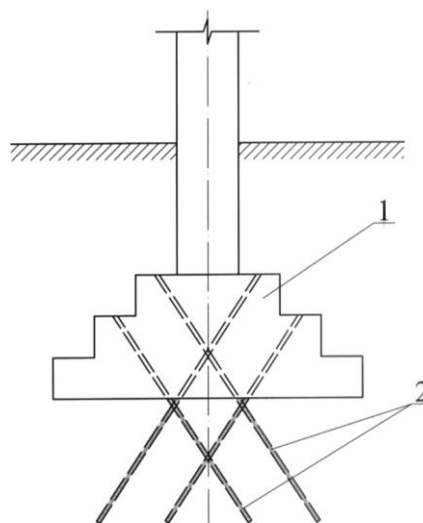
Усиление фундамента с помощью корневидных свай: 1 – усиливаемый фундамент; 2 – корневидные сваи
